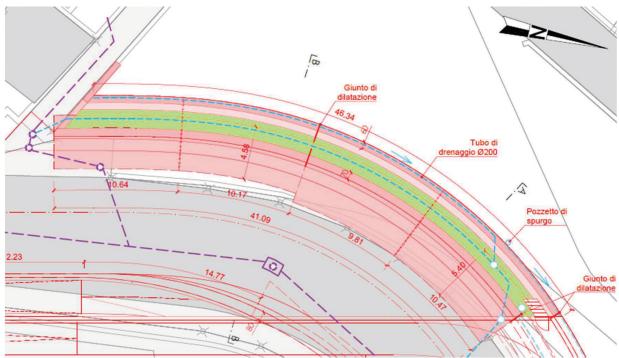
Planimetria dei muri di sostegno di via R. Manzoni
